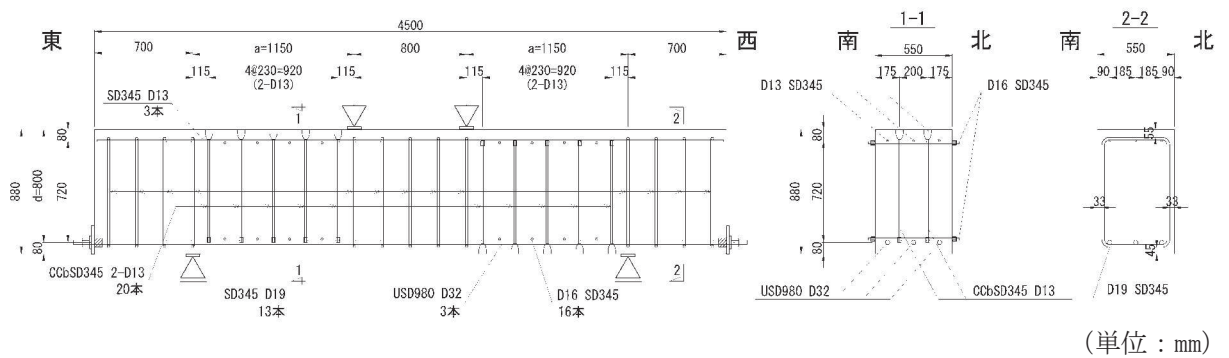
試験体概要 (CASE1: No. 1 試験体)
